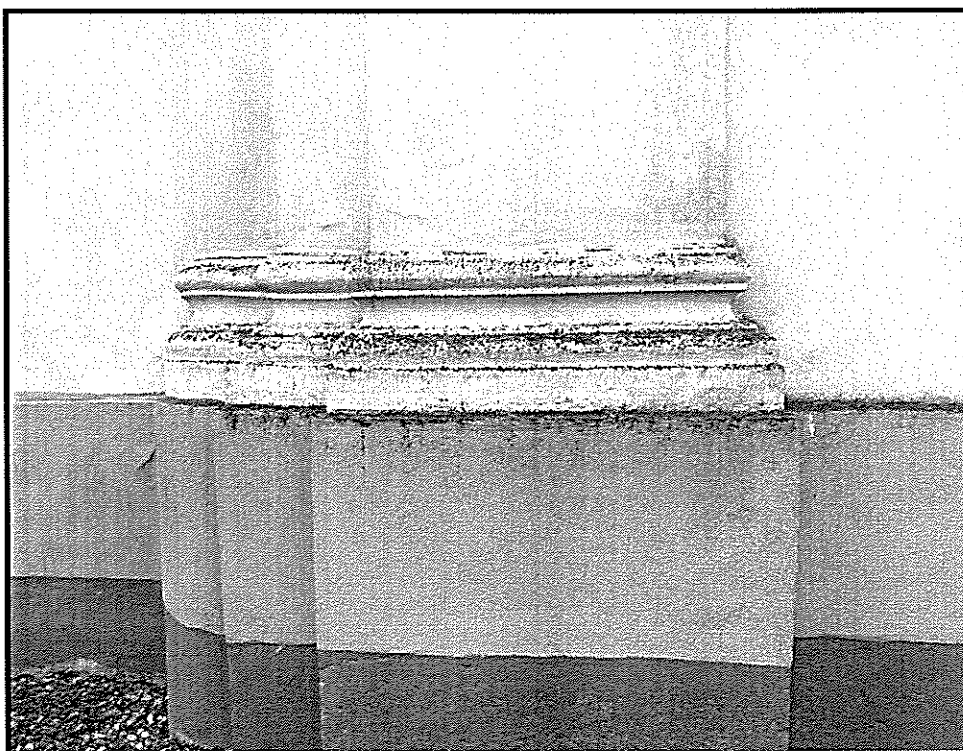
Zły stan zachowania tynku cokołu elewacji wschodniej.
